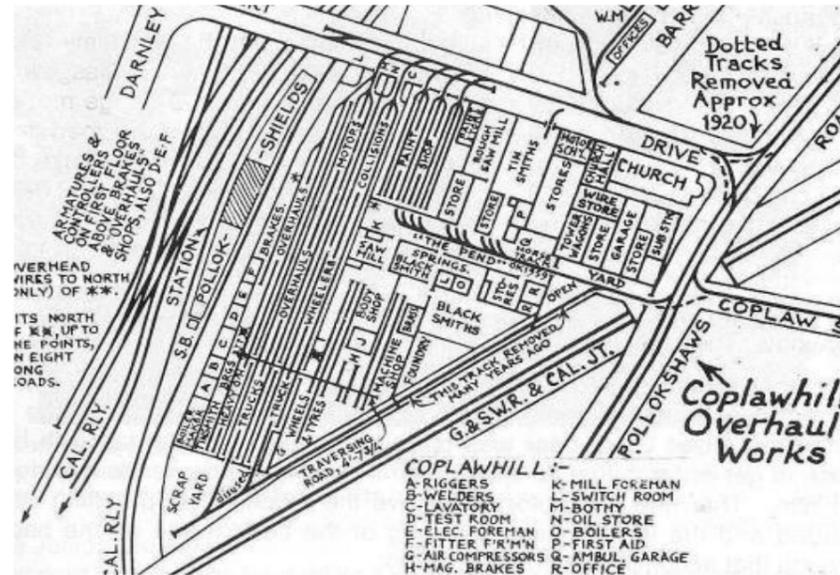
Der Grundriss der Remise im Jahr 1956
